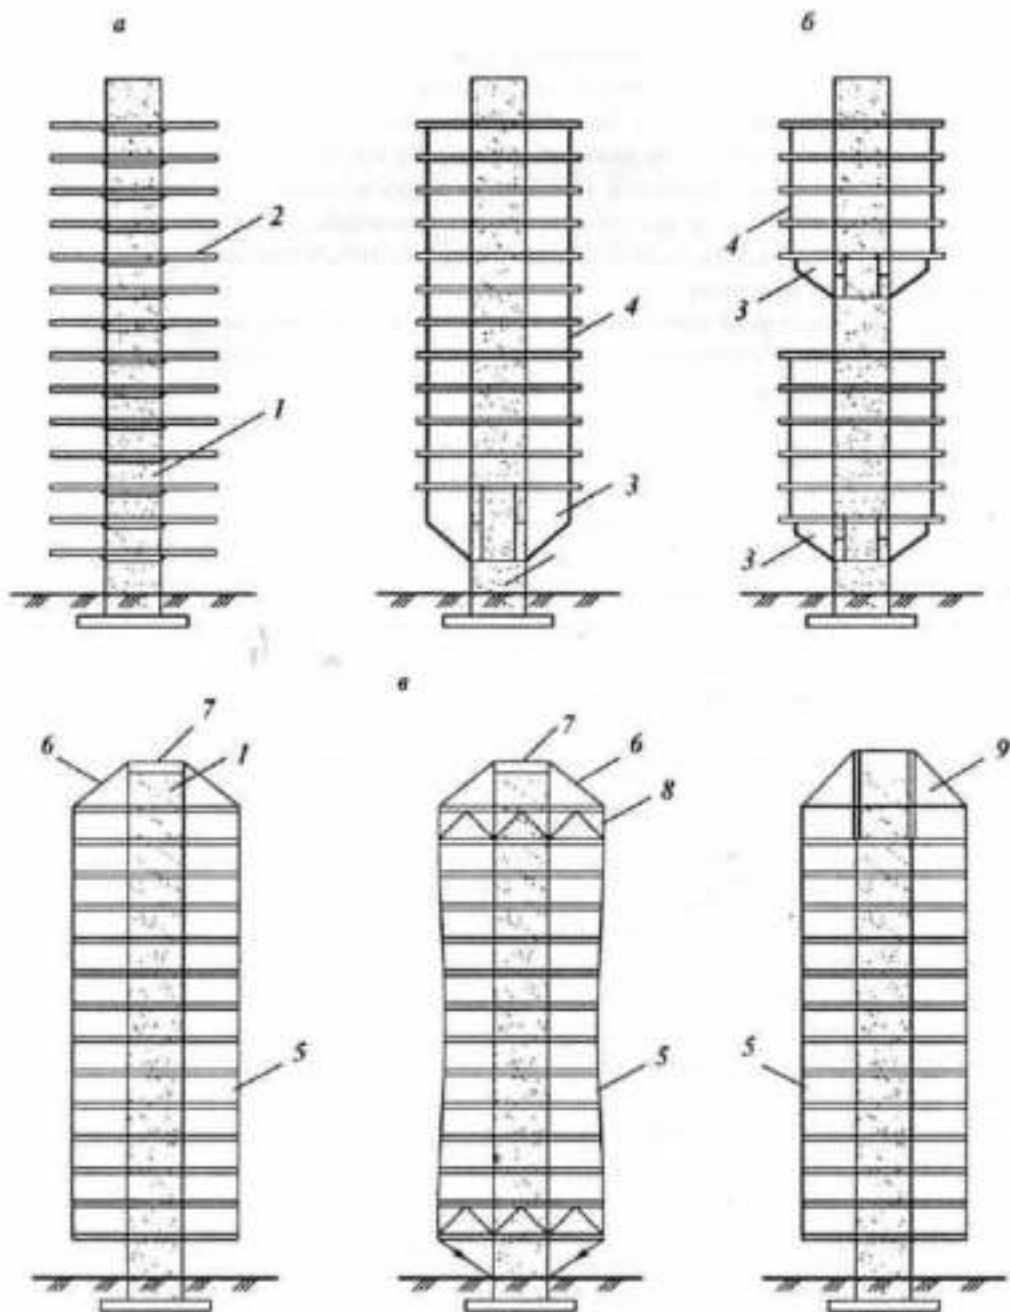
Основні конструктивні схеми будівель стовбурної конструктивної системи: а – з консольними перекриттями; б – з консольними платформами; в – із перекриттями, підвішеними на металевих підвісках до консольних оголовків; 1 – стовбур; 2 – перекриття; 3 – консольна платформа; 4 – фахверкова стіна; 5 – підвіска; 6 – відтяжка; 7 – анкерна обойма; 8 – металевий консольний оголовок; 9 – залізобетонний консольний оголовок
